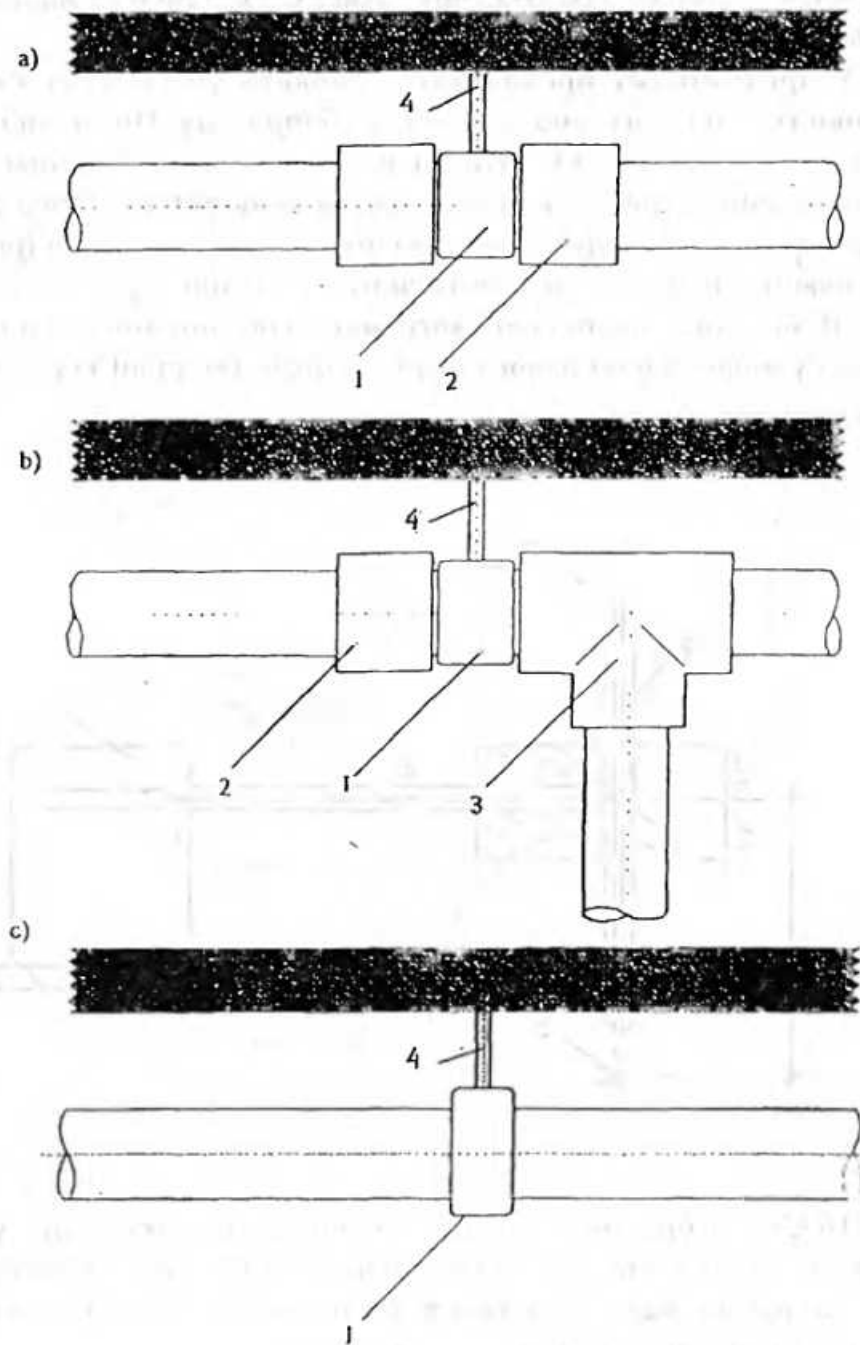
Опори пластмасових трубопроводів: а, б - нерухома; с - рухома; 1 - розбірний хомут; 2 - з'єднувальна муфта; 3 - трійник; 4 - елемент жорсткого кріплення хомута до будівельної конструкції
